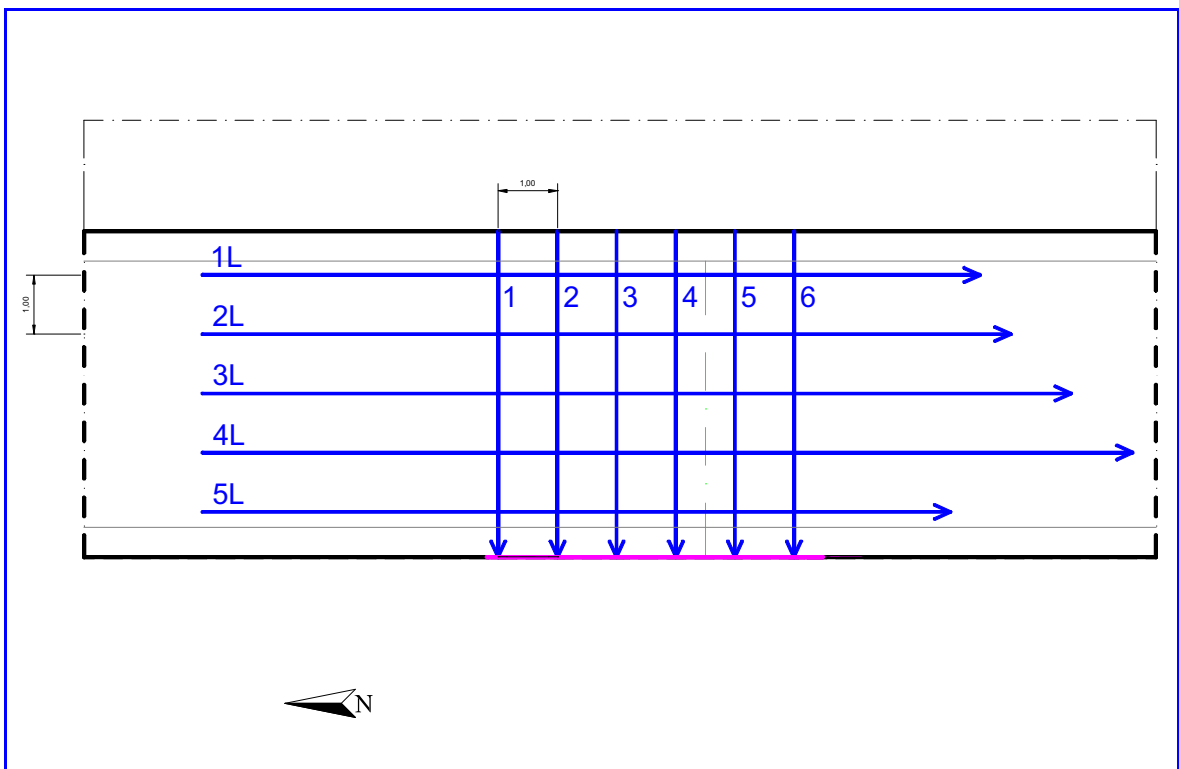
SP 34C - km 0+300 - Pianta dell'area di prova
